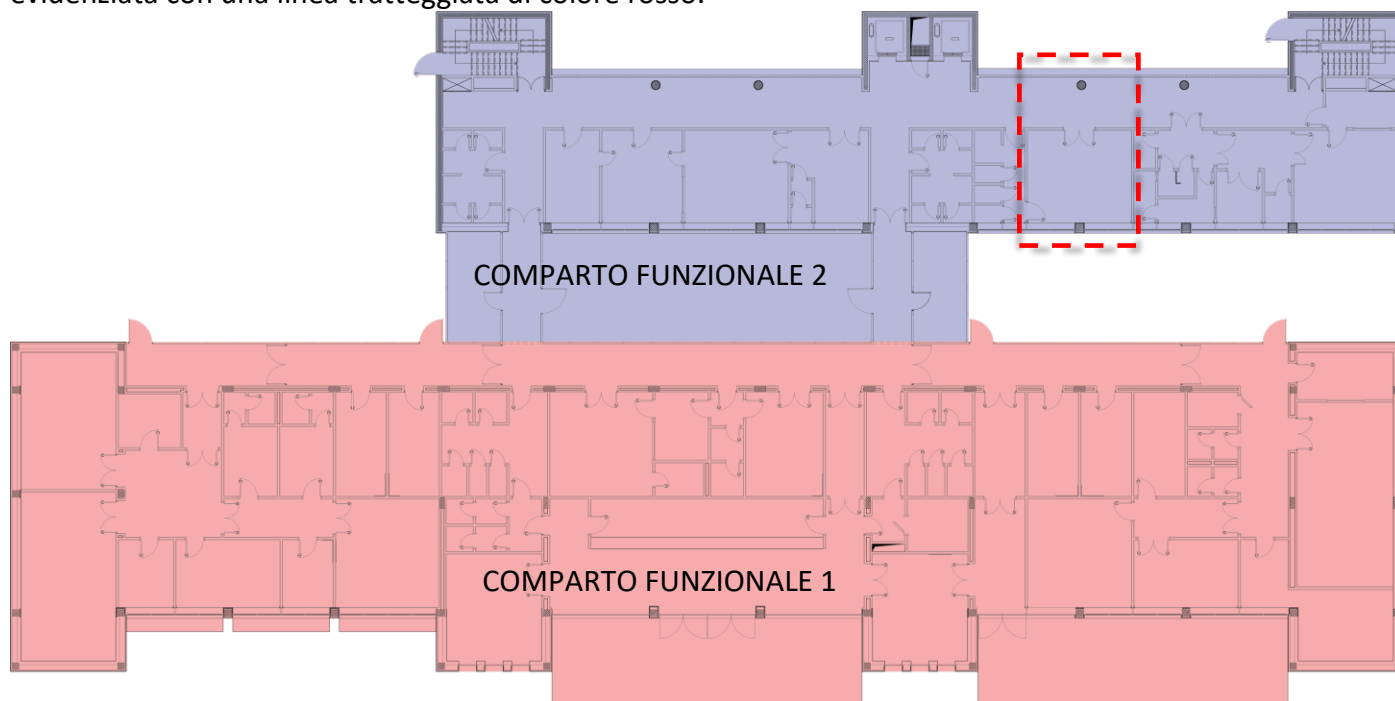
Planimetria tipo dell' I.T.A.B.
